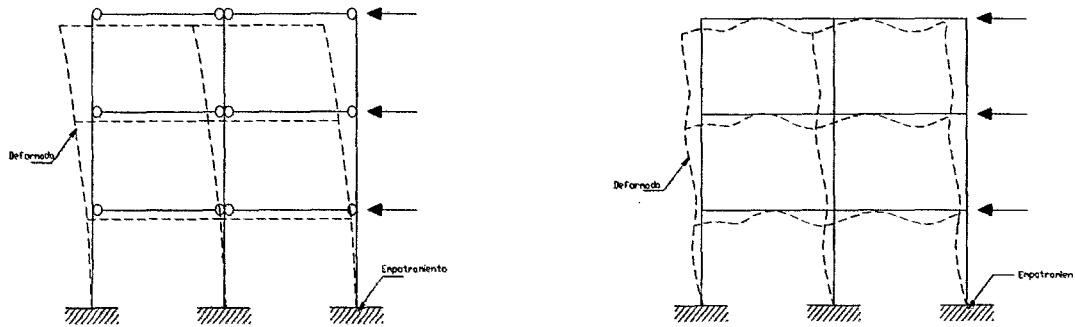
Estructuras en pórticos sin arriostramiento
